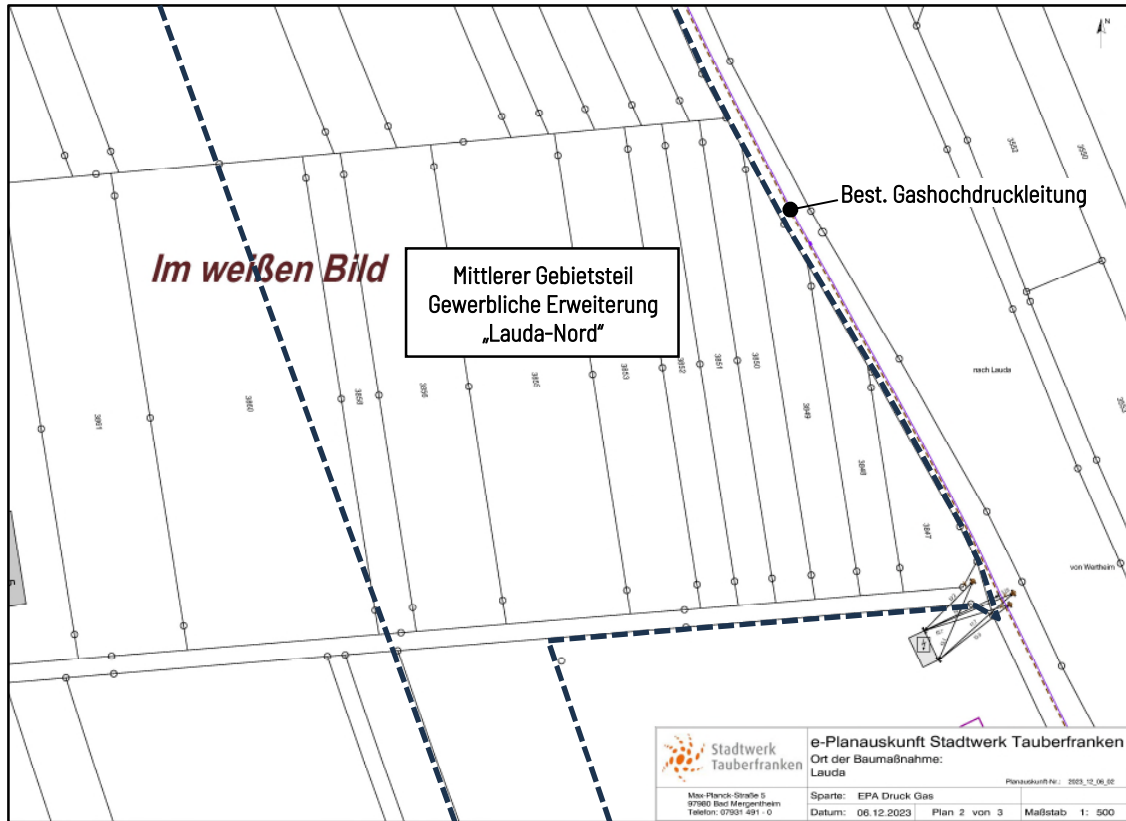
Bestandsplan Trasse Gashochdruckleitung – Quelle: Stadtwerk Tauberfranken
